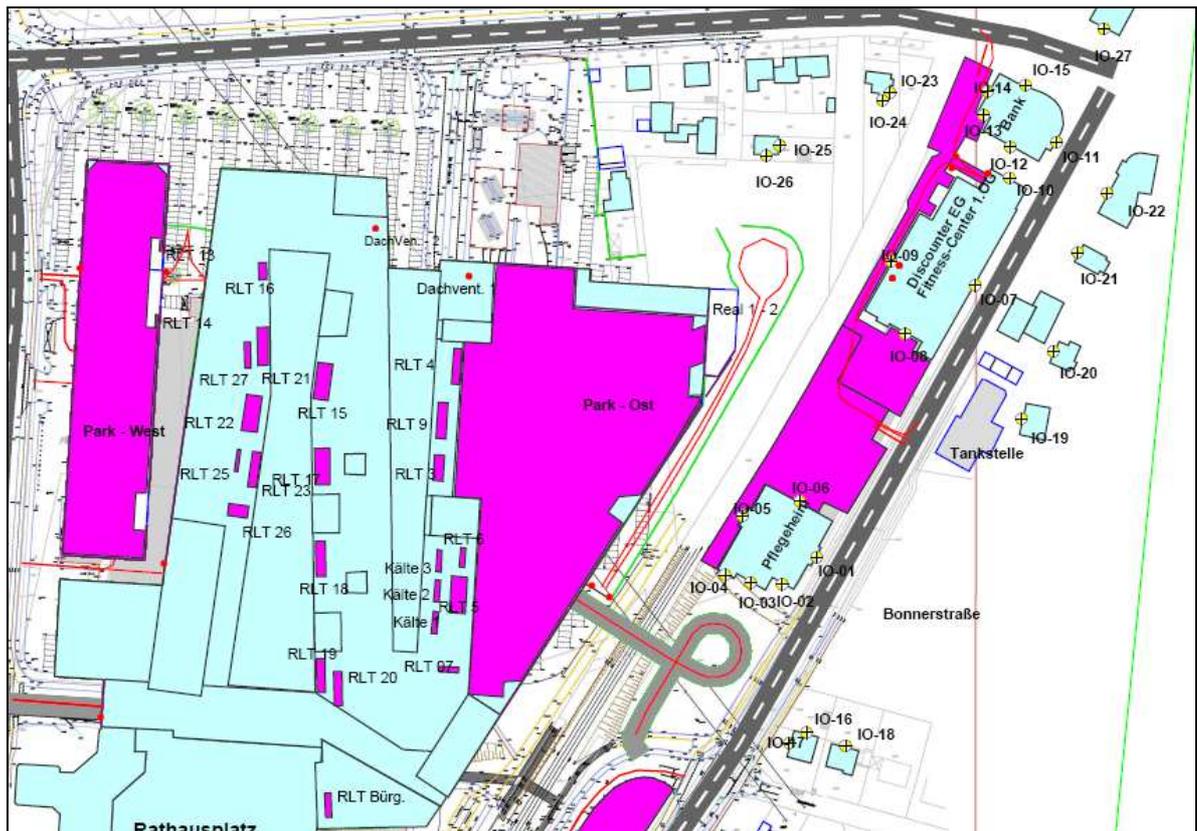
Lageplan Ausschnitt – Immissionsorte im eigenen Bereich
